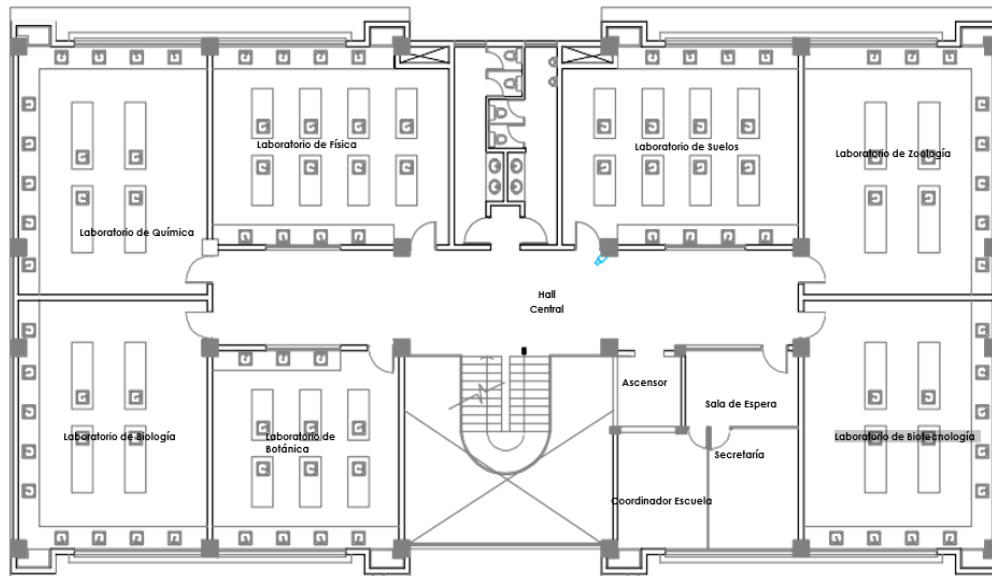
Planos de Infraestructura Primer Piso Laboratorios
